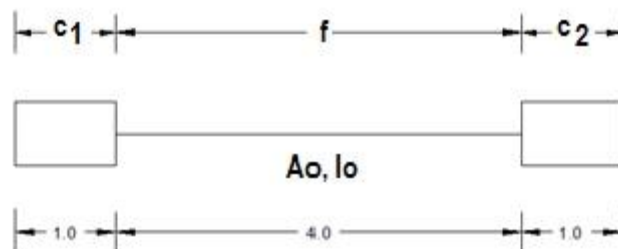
Pórtico con muros de corte sometida a cargas laterales.
